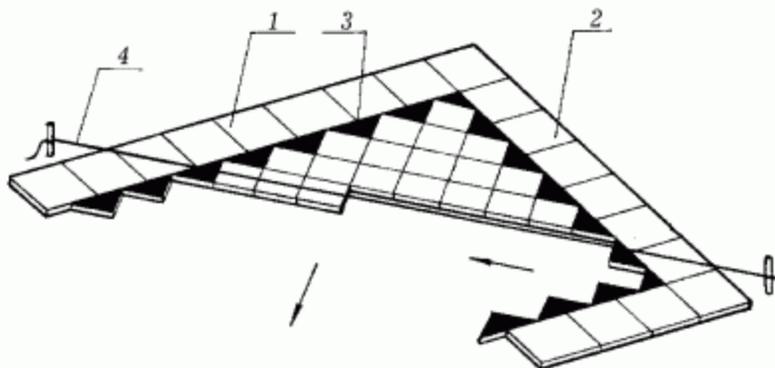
Укладка плитки диагональными рядами: 1, 2 – фризových ряды; 3 – ряд треугольных плиток; 4 – причальный шнур.
